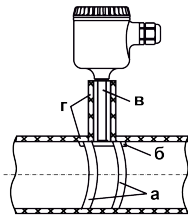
Монтаж датчика ДТС325M-RS: а) хомут; б) пластина-теплообменник; в) арматура датчика; г) теплоизоляционный материал для трубопровода
